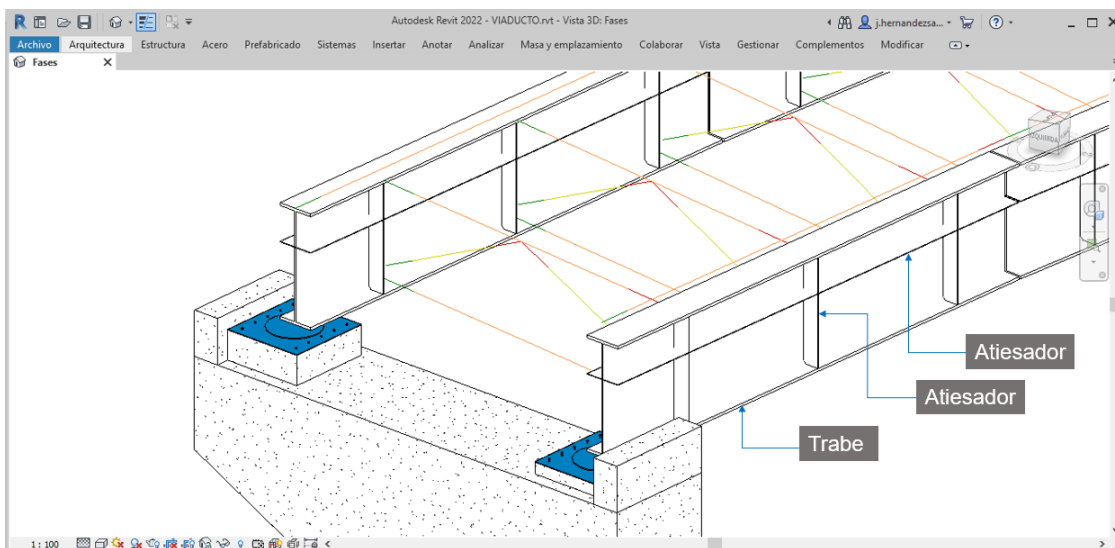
Modelado inicial de las traveses de acero. Fuente: Elaboración propia
